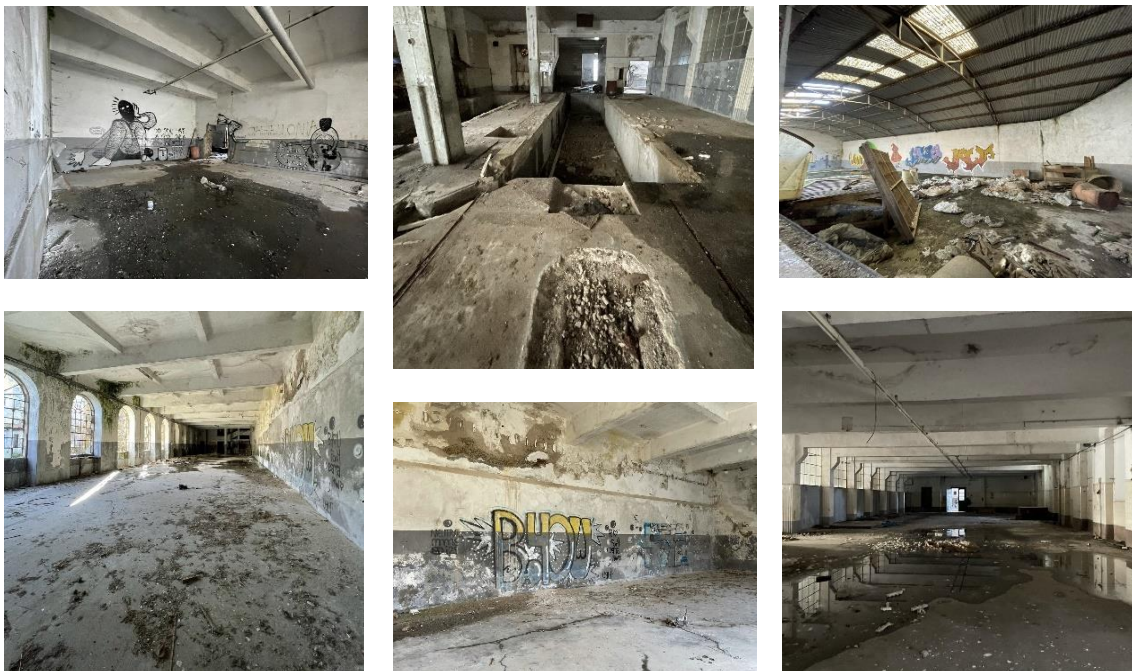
Paredes e pavimentos do edifício. Fotografias da autora, 2021.
